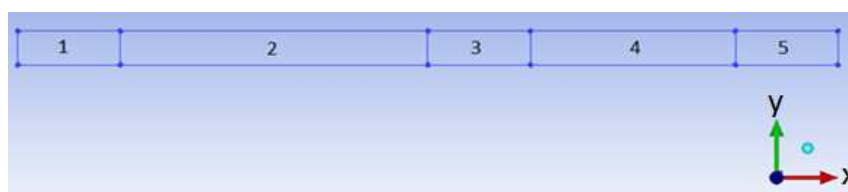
Часть стенки: 1, 3, 5 – стенки опалубки; 2 – бетон; 4 – утеплитель
